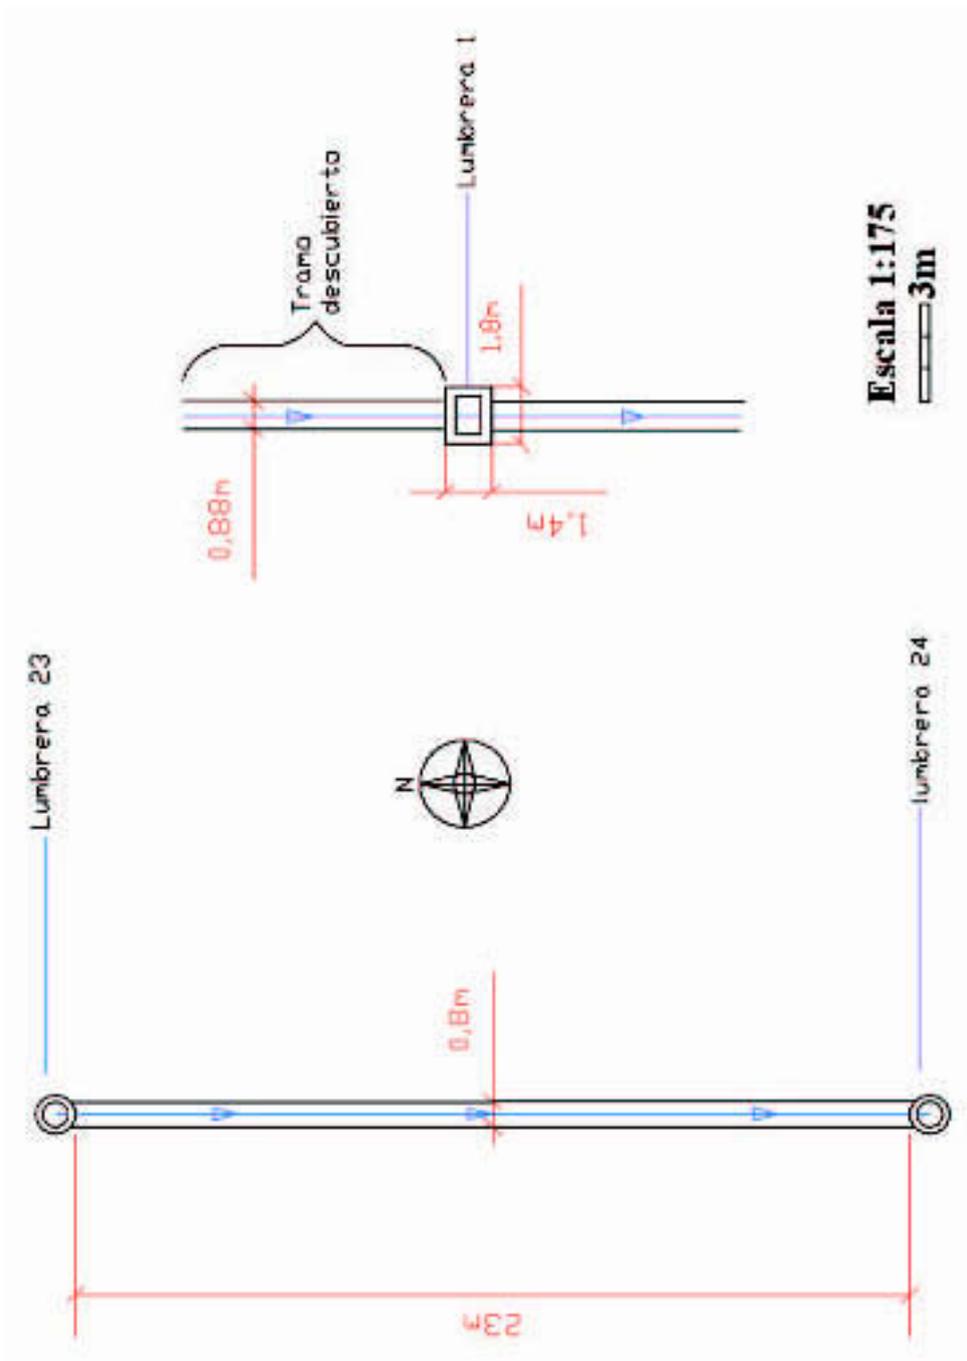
Tramos de la galería de Las Tobarrillas (Lumbreras 1, 23 y 24) vista en planta.
